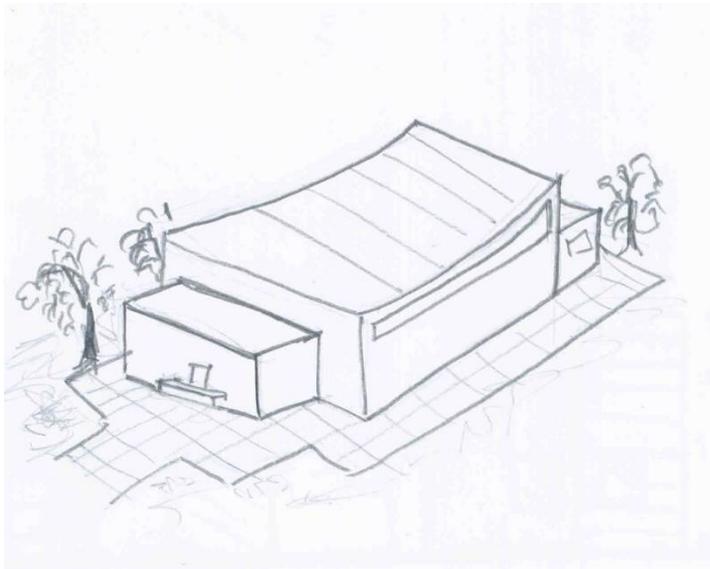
Boceto Planta Bungalows, Admón. Y Restaurante.
